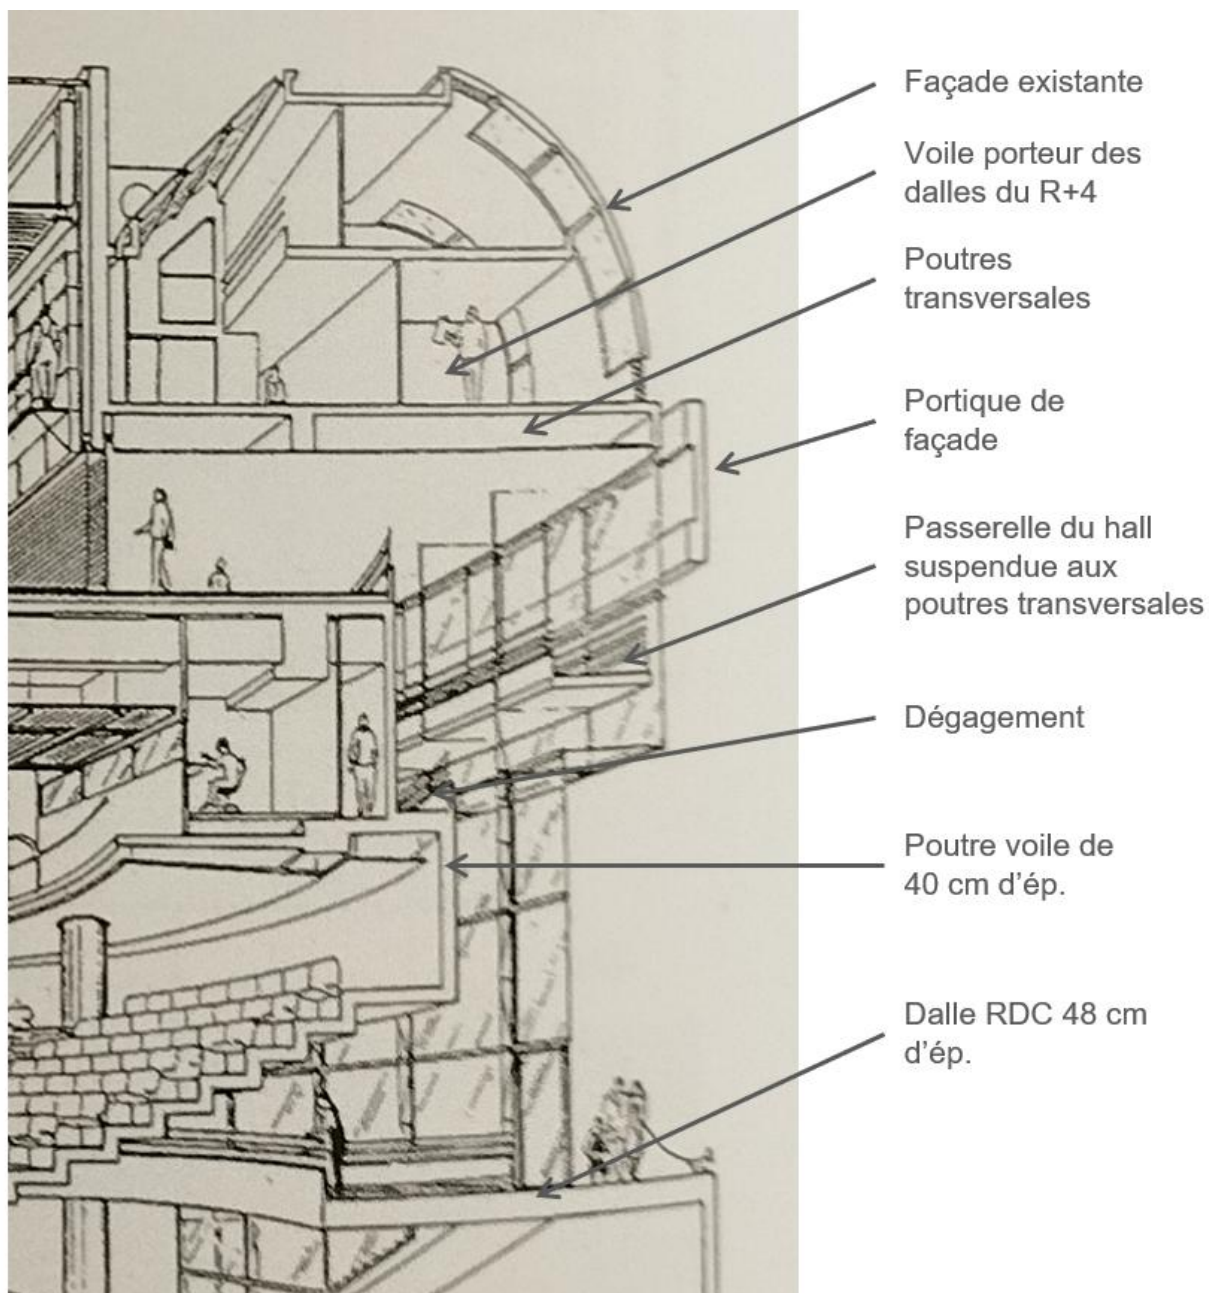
Perspective du bâtiment par les architectes Perrotet et XXX, avec légende des éléments structuraux
